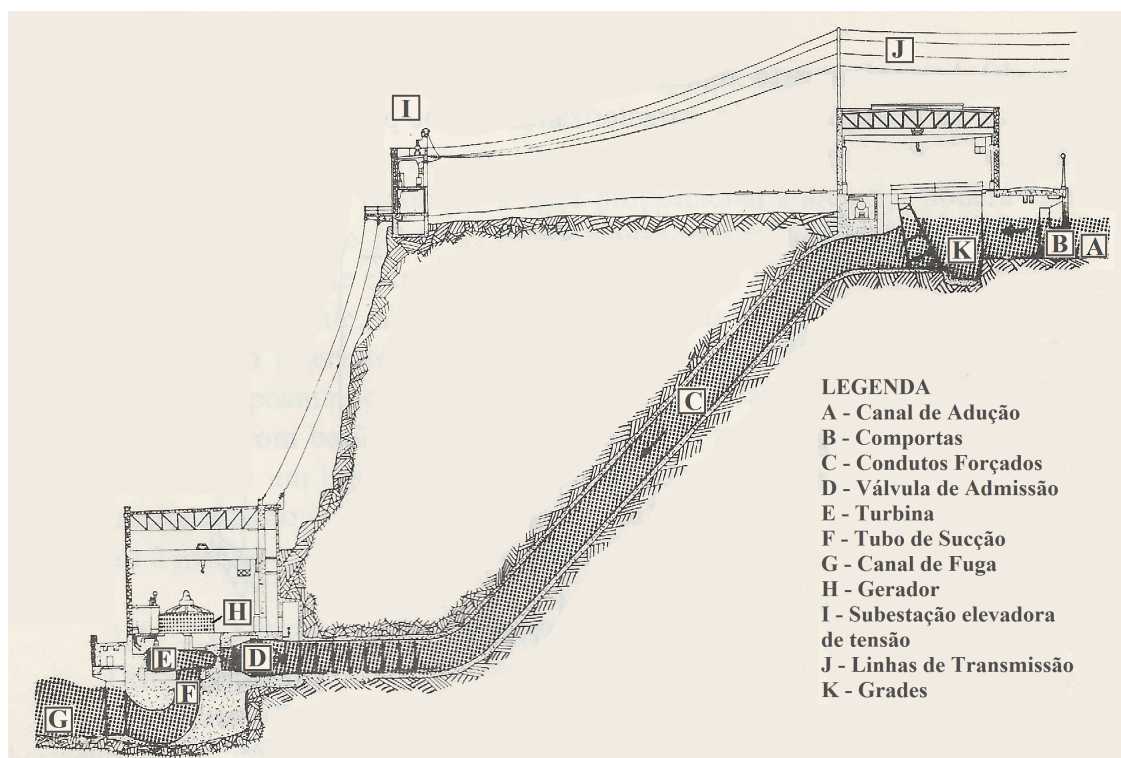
Partes principais de uma usina hidrelétrica. Imagem modificada de [1]
